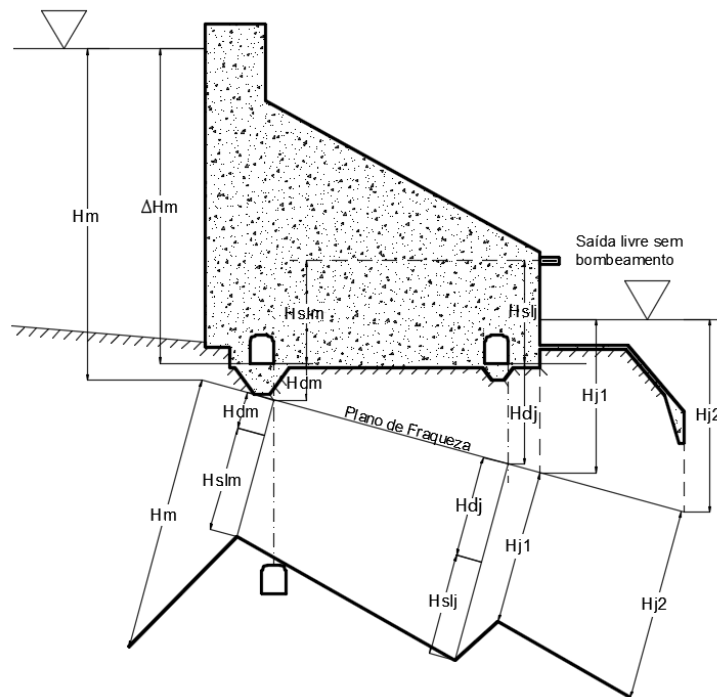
Cortinas de drenagem a Montante e Jusante na Estrutura com Túnel na Fundação
